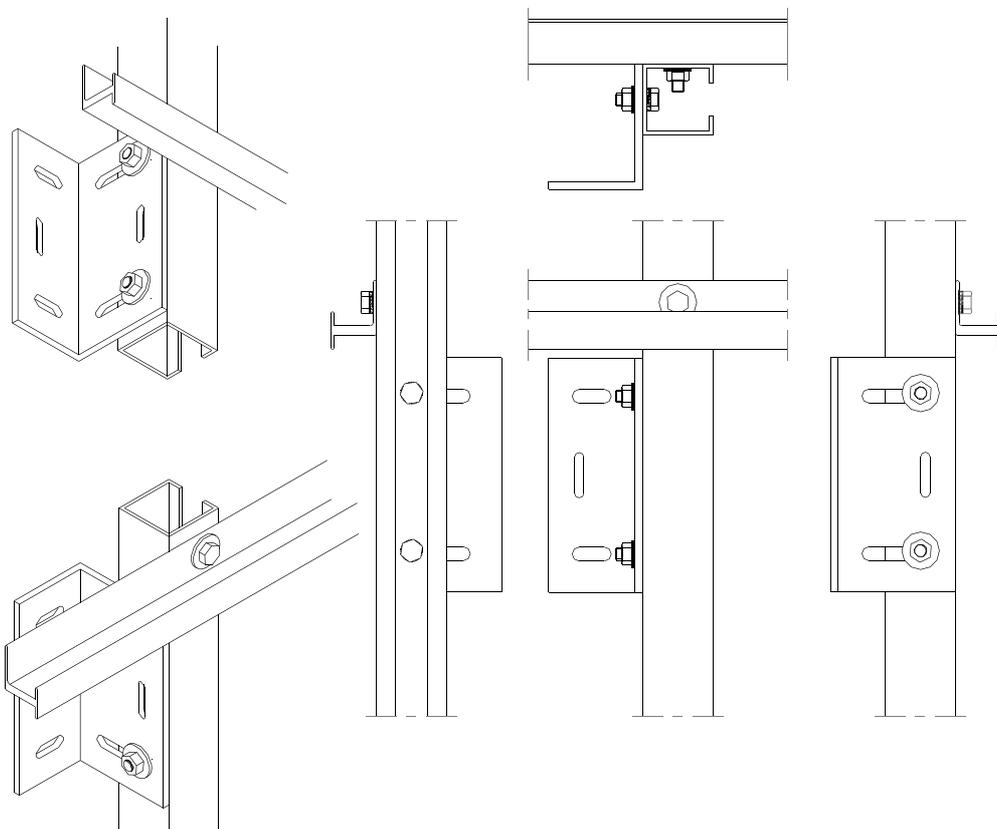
DETALLE DE JUNTAS ENTRE PERFILES HORIZONTALES Y VERTICALES
